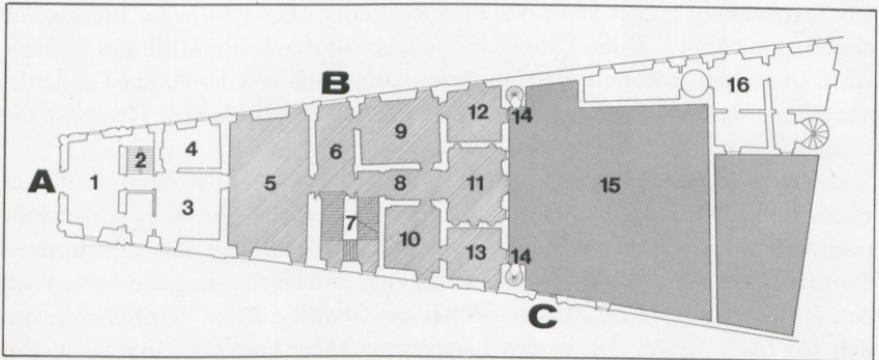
Grundriß des Erdgeschosses. Rekonstruktion nach dem alten Plan Abbildung 4. Die Ziffern 1 bis 16 bedeuten:
